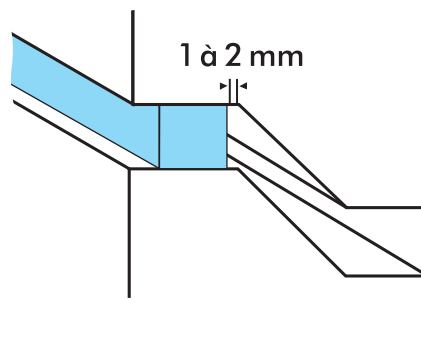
exemple d'étanchéité sous élément préfabriqué lourd
